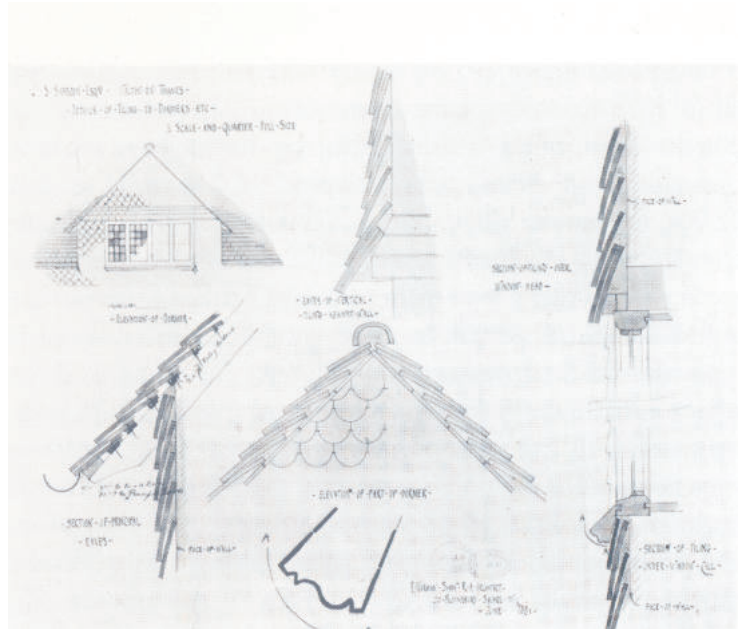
Vivienda en Av. Meeks, Lomas de Zamora. Fig.Nº147: Detalles de revestimiento tipo *tile-hanging* (1881); en Ashley Park, en Walton-on-Thames. Fig.Nº148: Ellern Mede (1876-7), arq. J.Nash; en Totteridge, Londres Fig.Nº149: Vivienda con revestimiento tipo *tile-hanging*, arq. R.N.Shaw; Bedford Park. Fig.Nº150: Casa-estudio para K.Greenaway (1883), arq. R.N.Shaw; en Nº39 Frongal, Hampstead, Londres. Fig.Nº151: Vivienda (1914), arq. Baillie Scott; Storey's Way, Cambridge. Fig.Nº152: Antigua foto de vivienda en Av. Meeks Nº1057, Lomas de Zamora.
